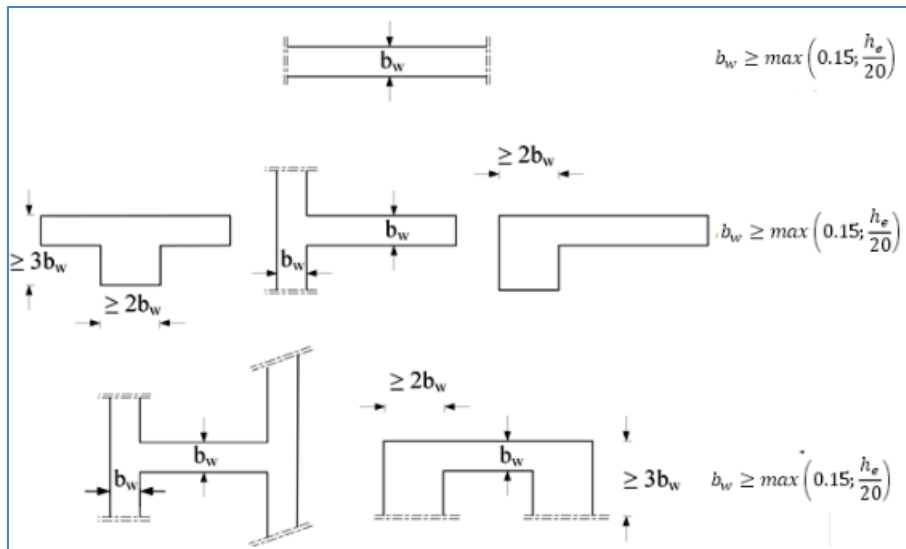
Epaisseur minimum des voiles selon la configuration
